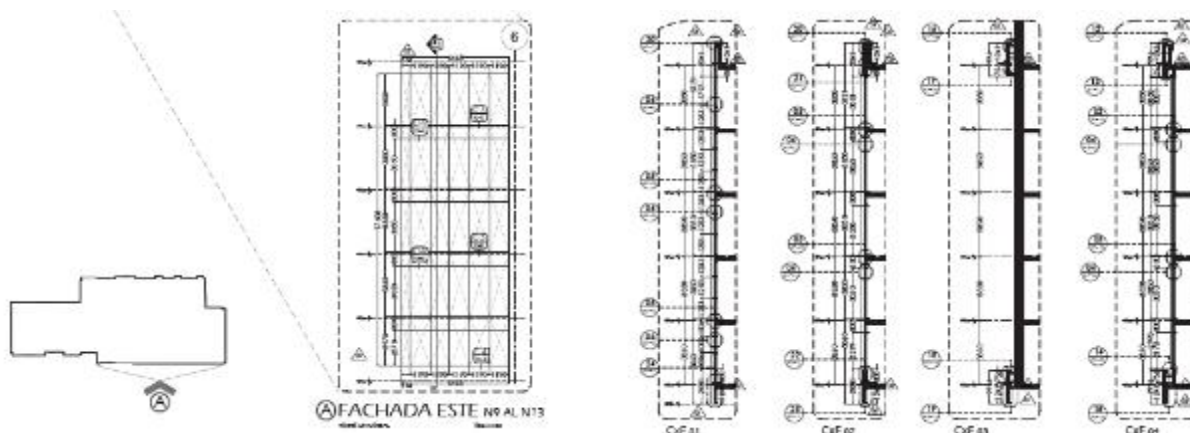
Continuación detalle en planos fachada este, ejemplo de visualización de paneles en proyecto. Fuente: Extralum (2019)
